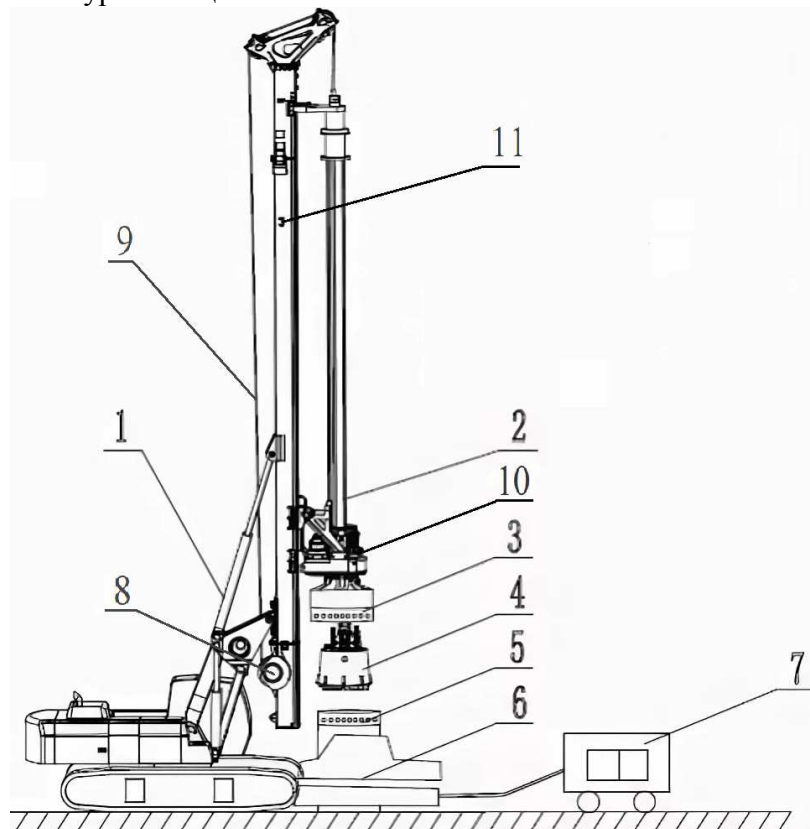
Конструктивная схема буровой установка роторного типа с рабочим оборудованием «штанга Келли», где 1 – гидроцилиндр подъема/опускания мачты; 2 – буровая штанга Келли; 3 – дрейтеллер; 4 – буровая голова/шнек; 5 – обсадная труба; 6 – обсадной стол; 7 – гидростанция; 8 – лебедка подъема/опускания бурового инструмента; 9 – буровой канат; 10 – ротор, 11 – штанга
